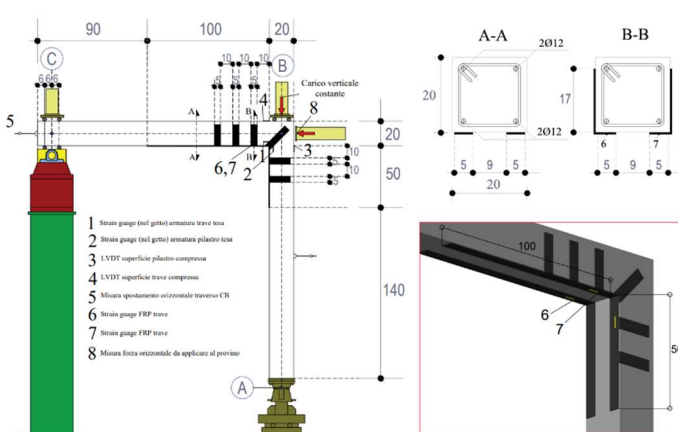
Set-up del telaio in calcestruzzo armato rinforzato con BFRP
